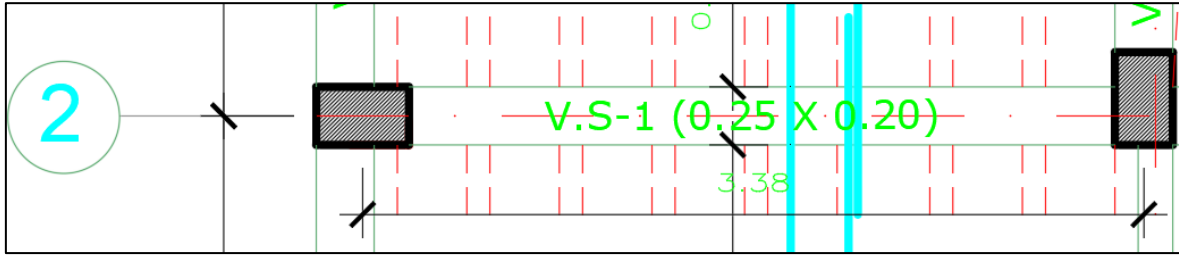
Detalle de predimensionamiento de Viga eje 2.
